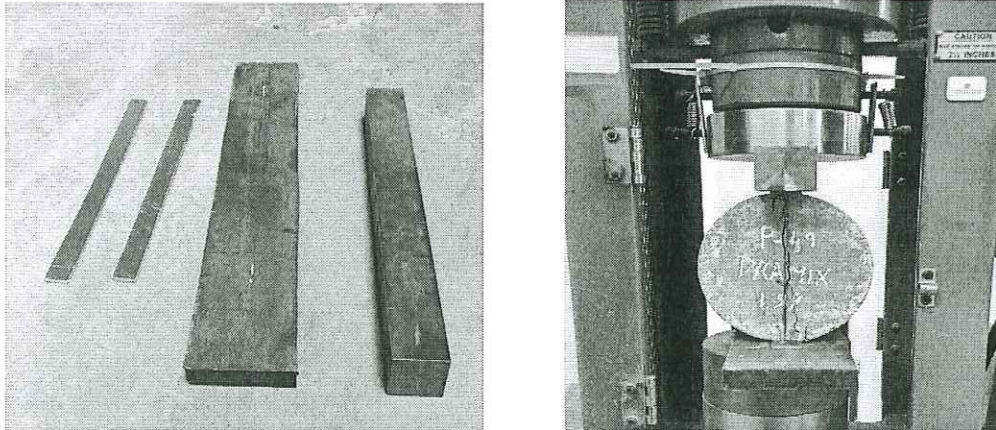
Vistas generales del equipo adecuado para la determinación del ensayo
